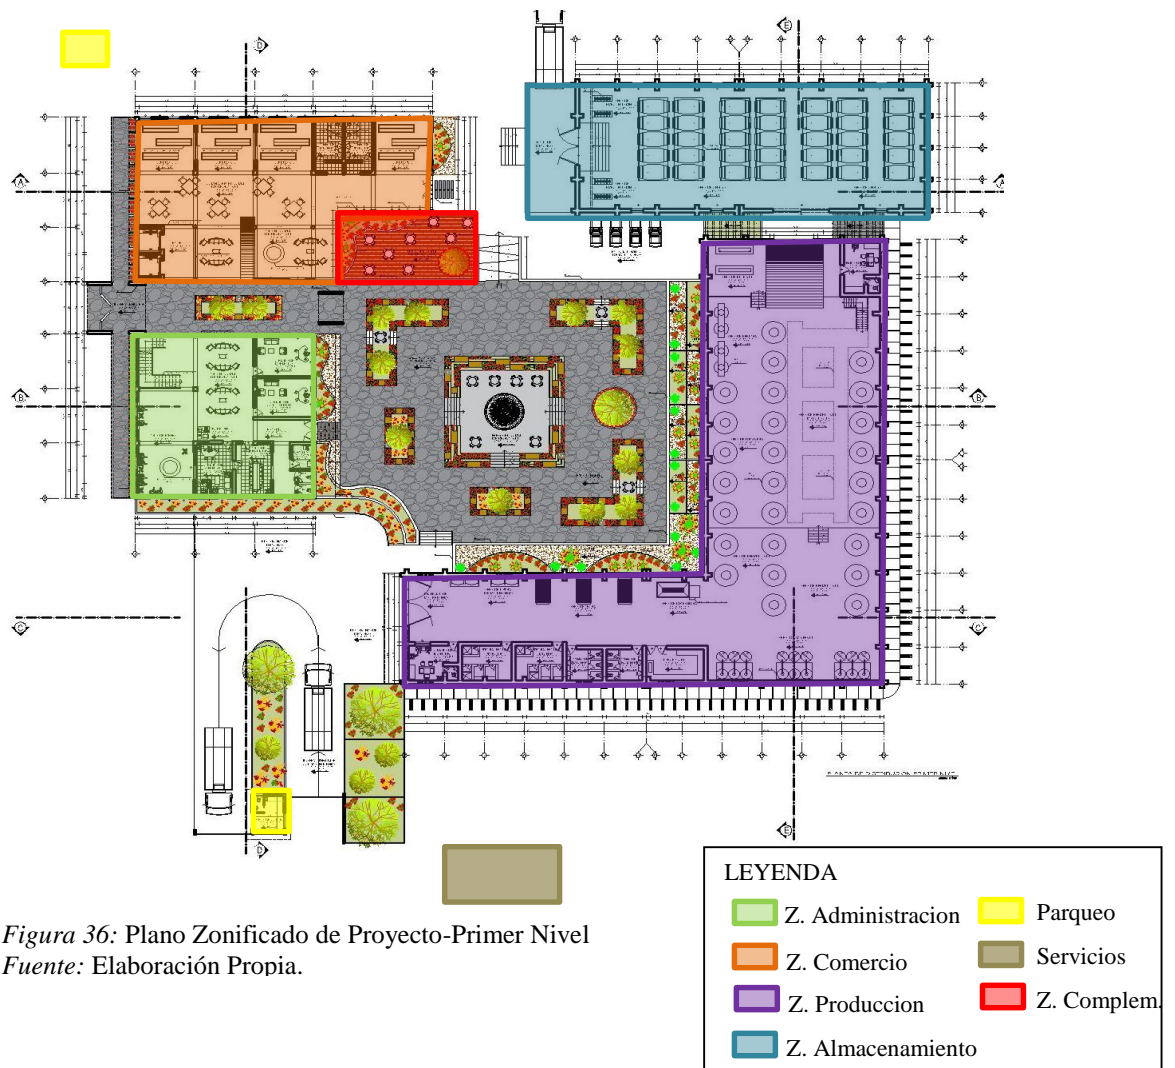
Plano Zonificado de Proyecto-Primer Nivel
